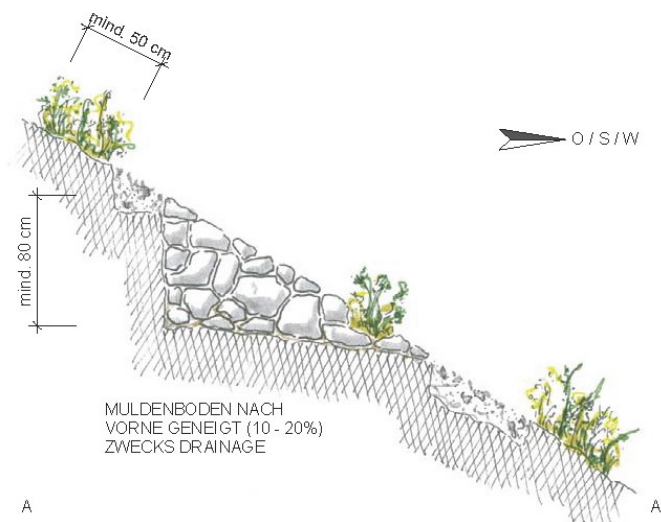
Coupe transversale d'une niche pierreuse (source : Barbara Kirsch / Karch)
